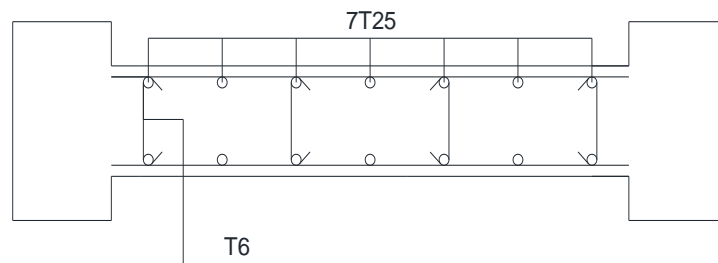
Schéma de ferrailage du voile (poutres noyées - plan légèrement irrégulier)
